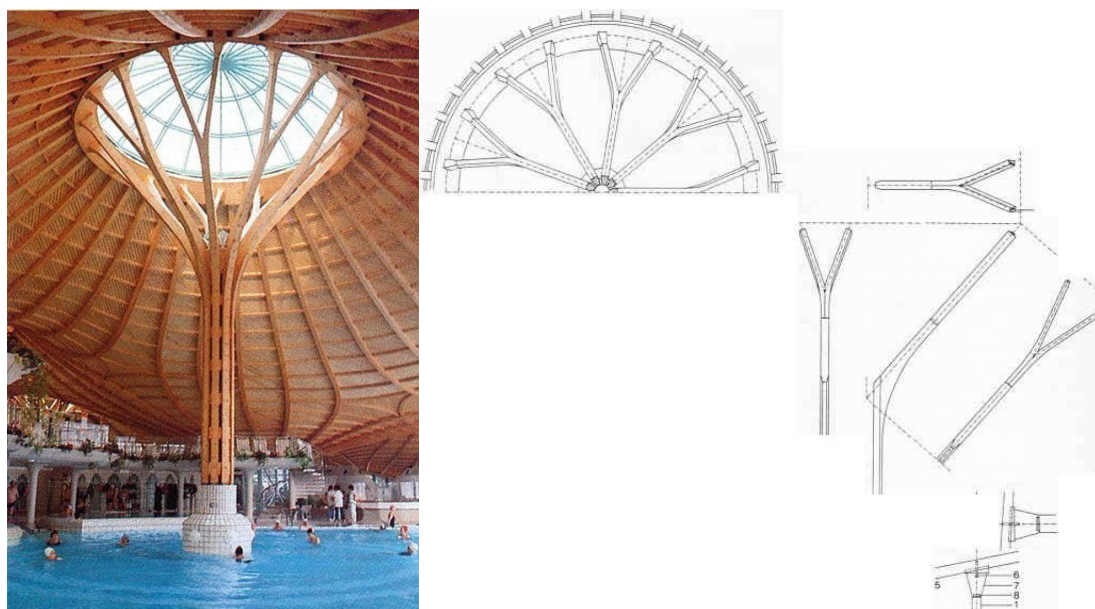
Общий вид и схема конструкции кровли сооружения
